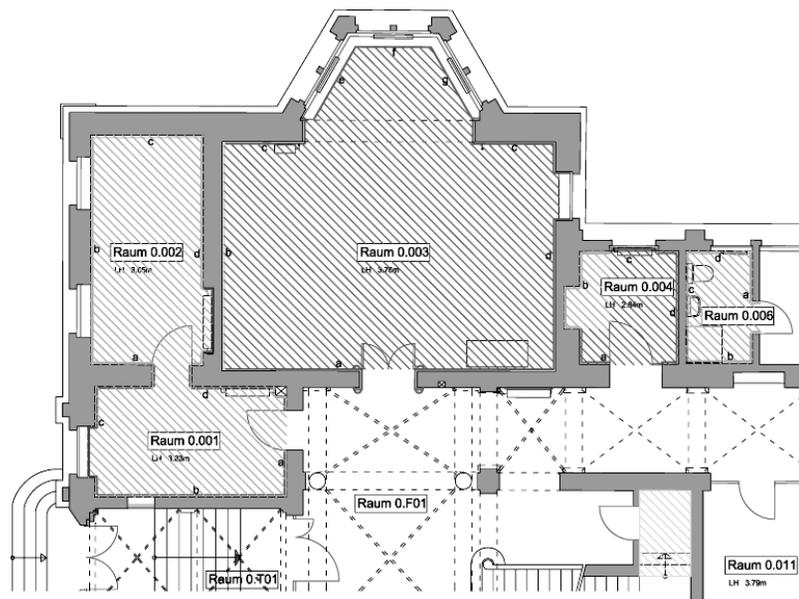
Ampelplan, Ausschnitt Erdgeschoss (Wiedergabe macht nur bei Farbdruck Sinn)
